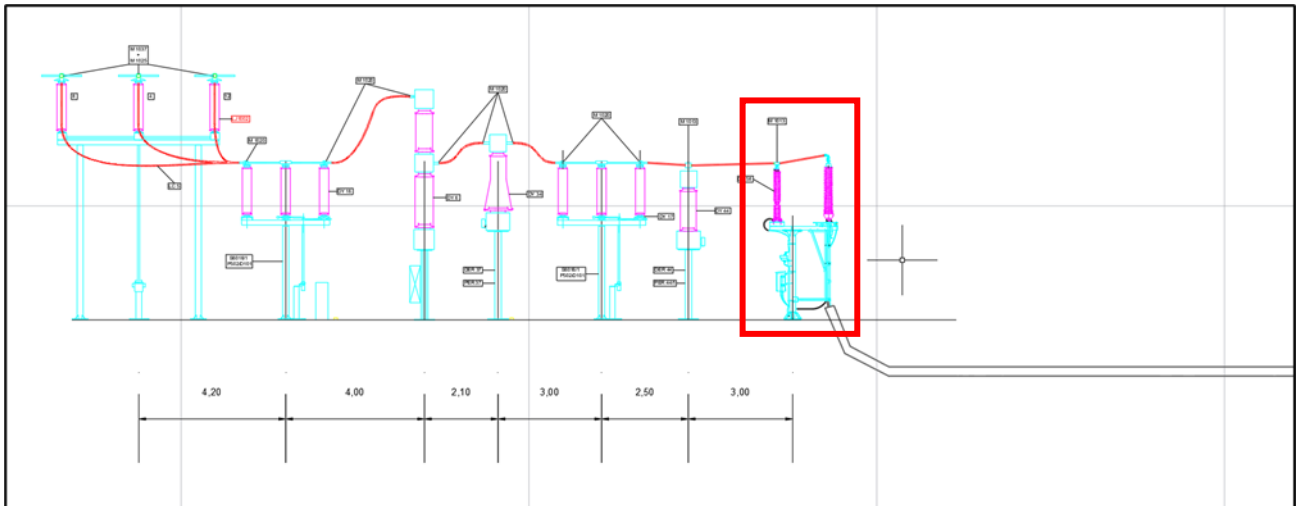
Sezione Stallo Arrivo Produttore con indicazione del punto di confine tra l'impianto di rete per la connessione e l'impianto di Utente (riquadro in rosso)
